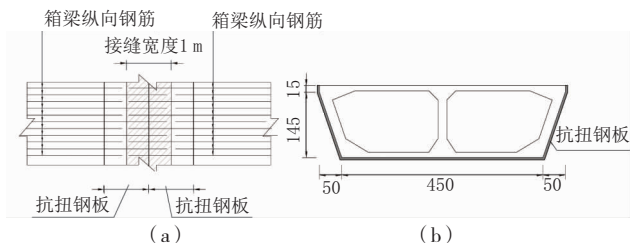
接缝处纵向钢筋及抗扭钢板布置示意图(单位:cm)
